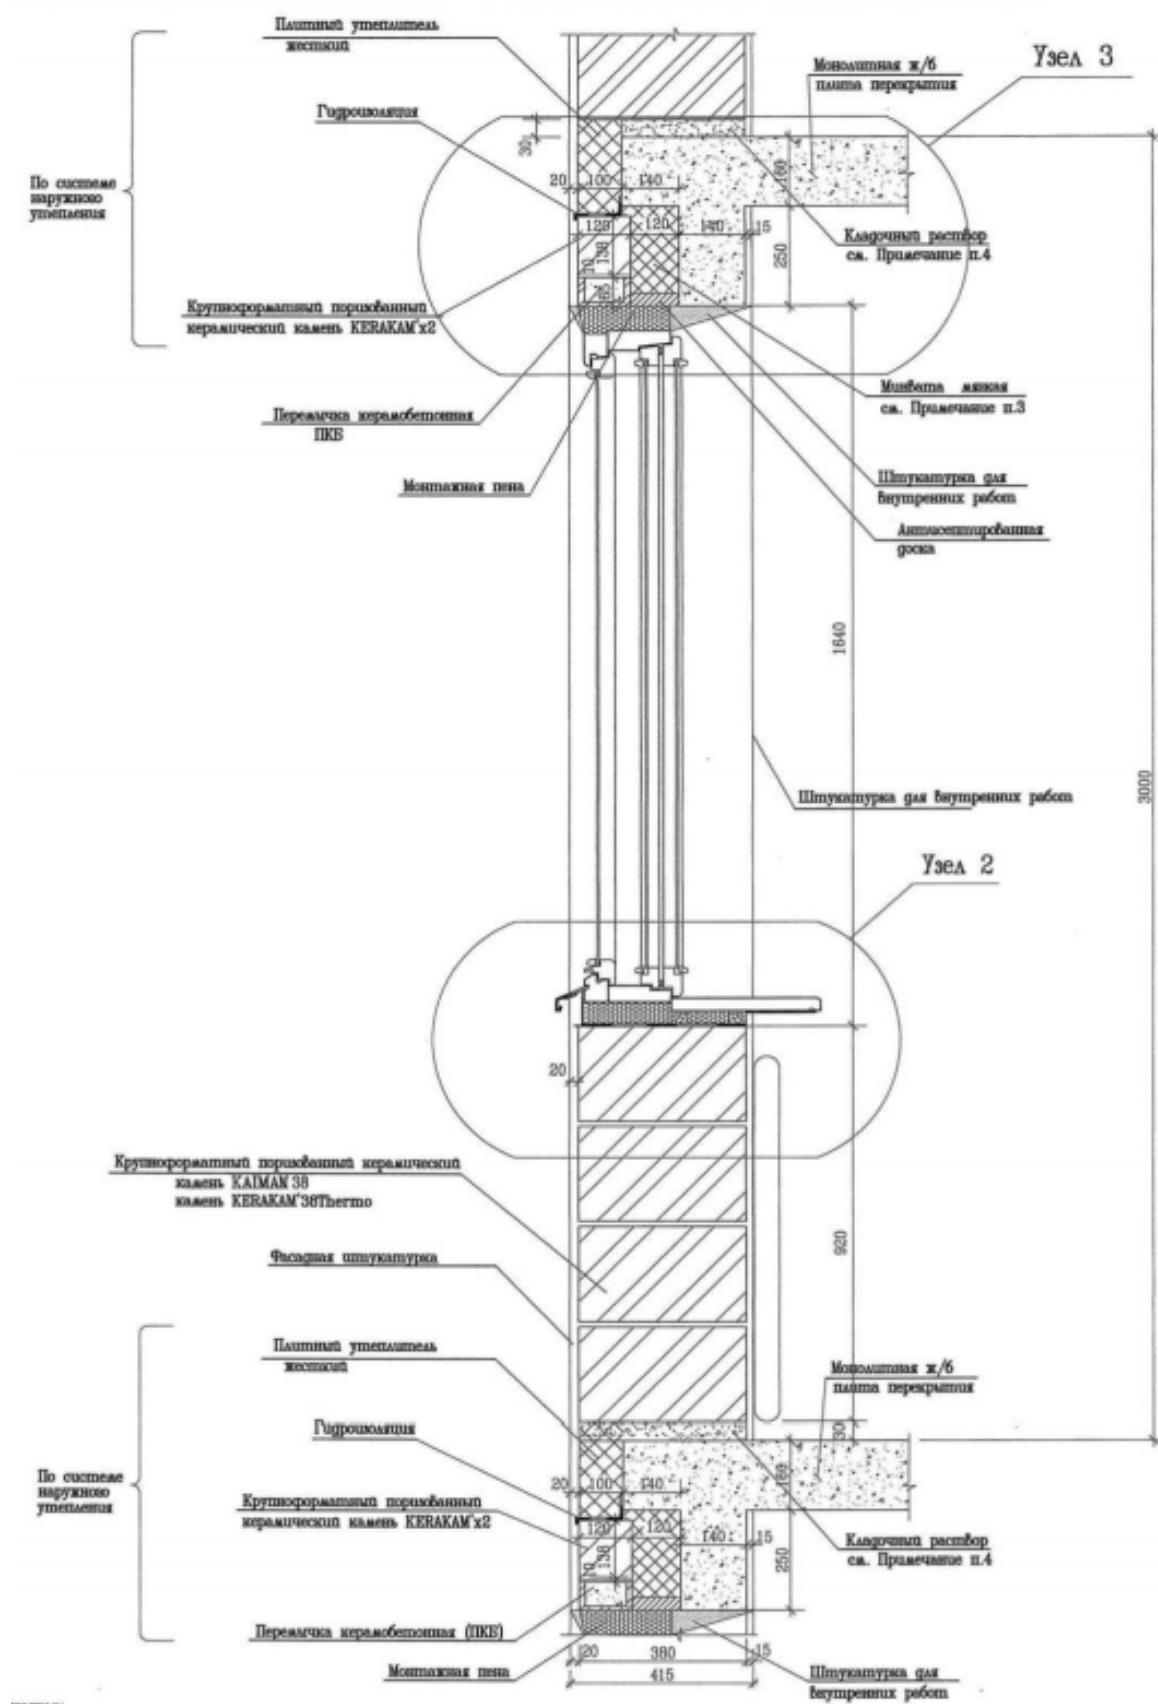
Разрез стены с плитой перекрытия с балкой с проемами.
